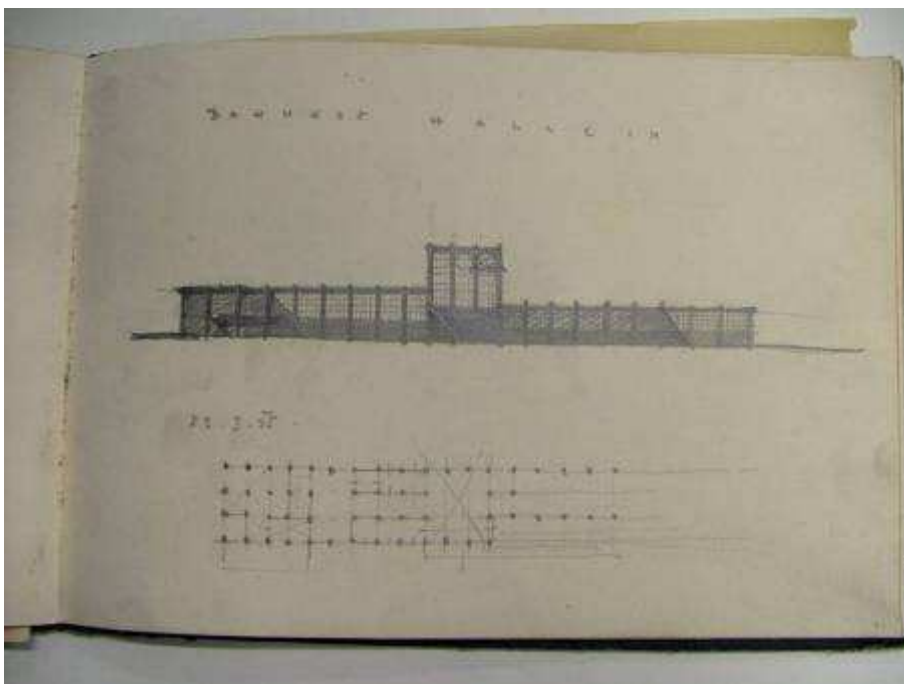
Otto Strohmayr, *Grundriss und Ansicht, Bahnhof, Hallein*, 23. Jänner 1925 (HSS, INR 1674-1675).
